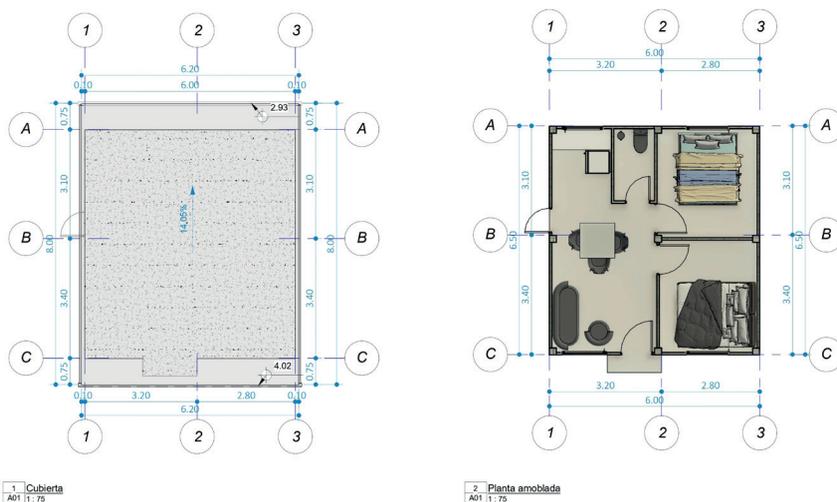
Planta arquitectónica y plano de cubierta de vivienda unifamiliar tipología Costa.
